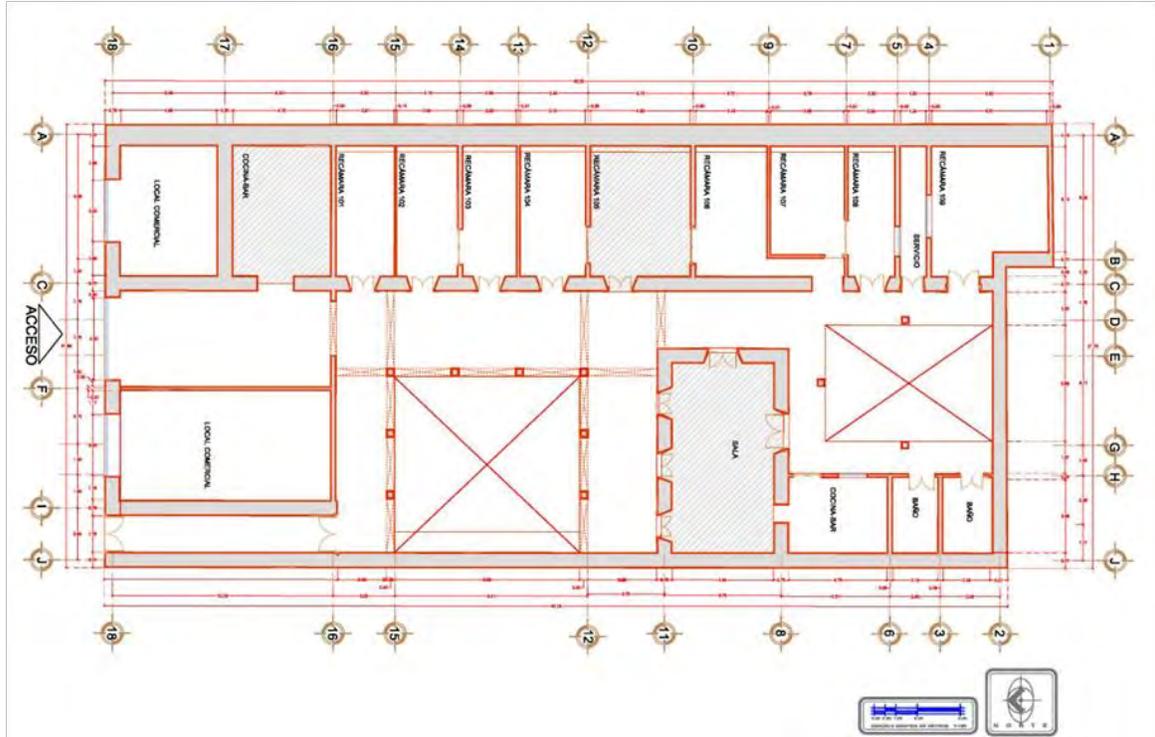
Planta Arquitectónica del Hotel Casa Limonchelo.
